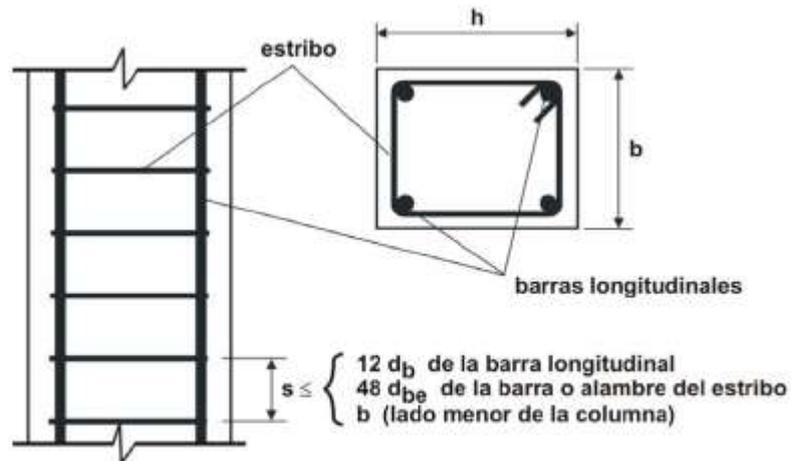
Separación vertical de los estribos cerrados.
